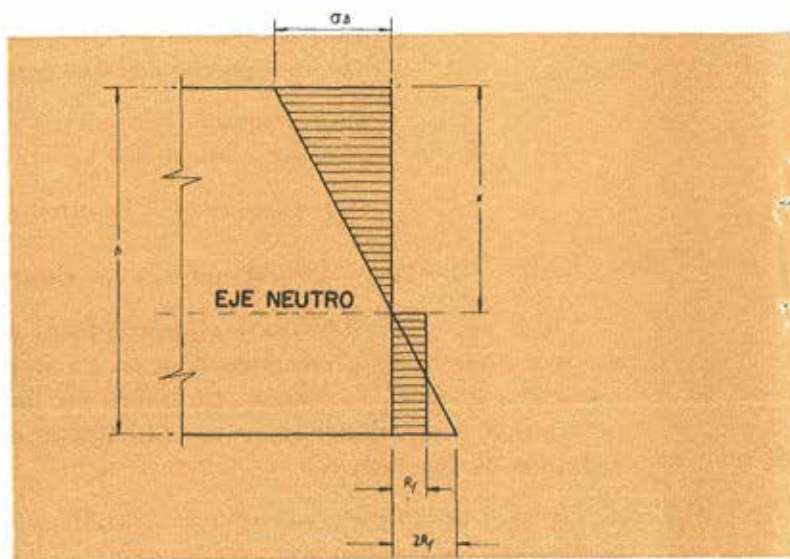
Distribución de tensiones, antes de la fisuración, en la sección de un elemento de hormigón pretensado.
